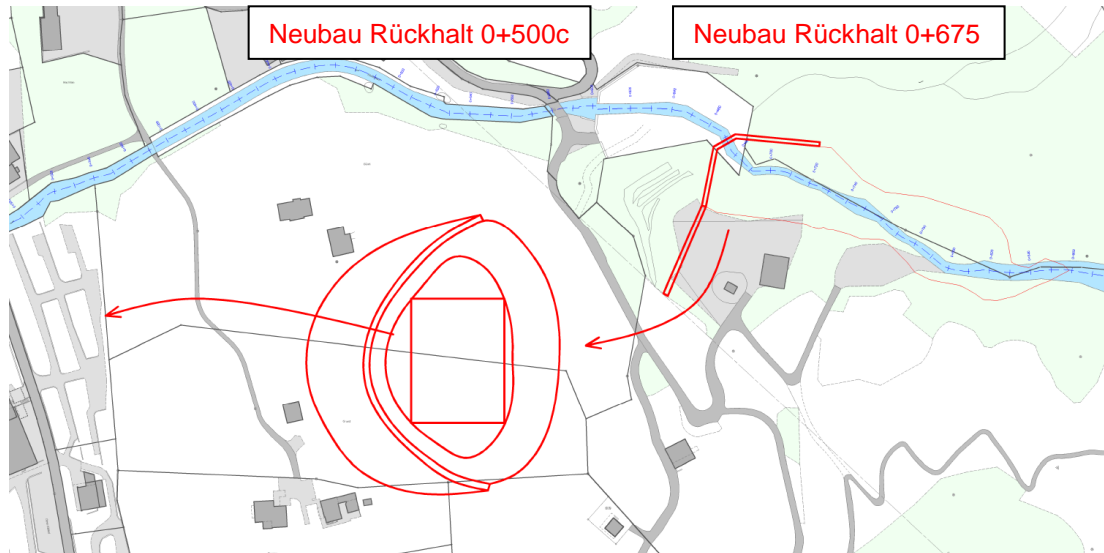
Variante 12, Neubau Rückhalt 0+675, Bau einer Überleitung, Neubau Rückhalt 0+500c
